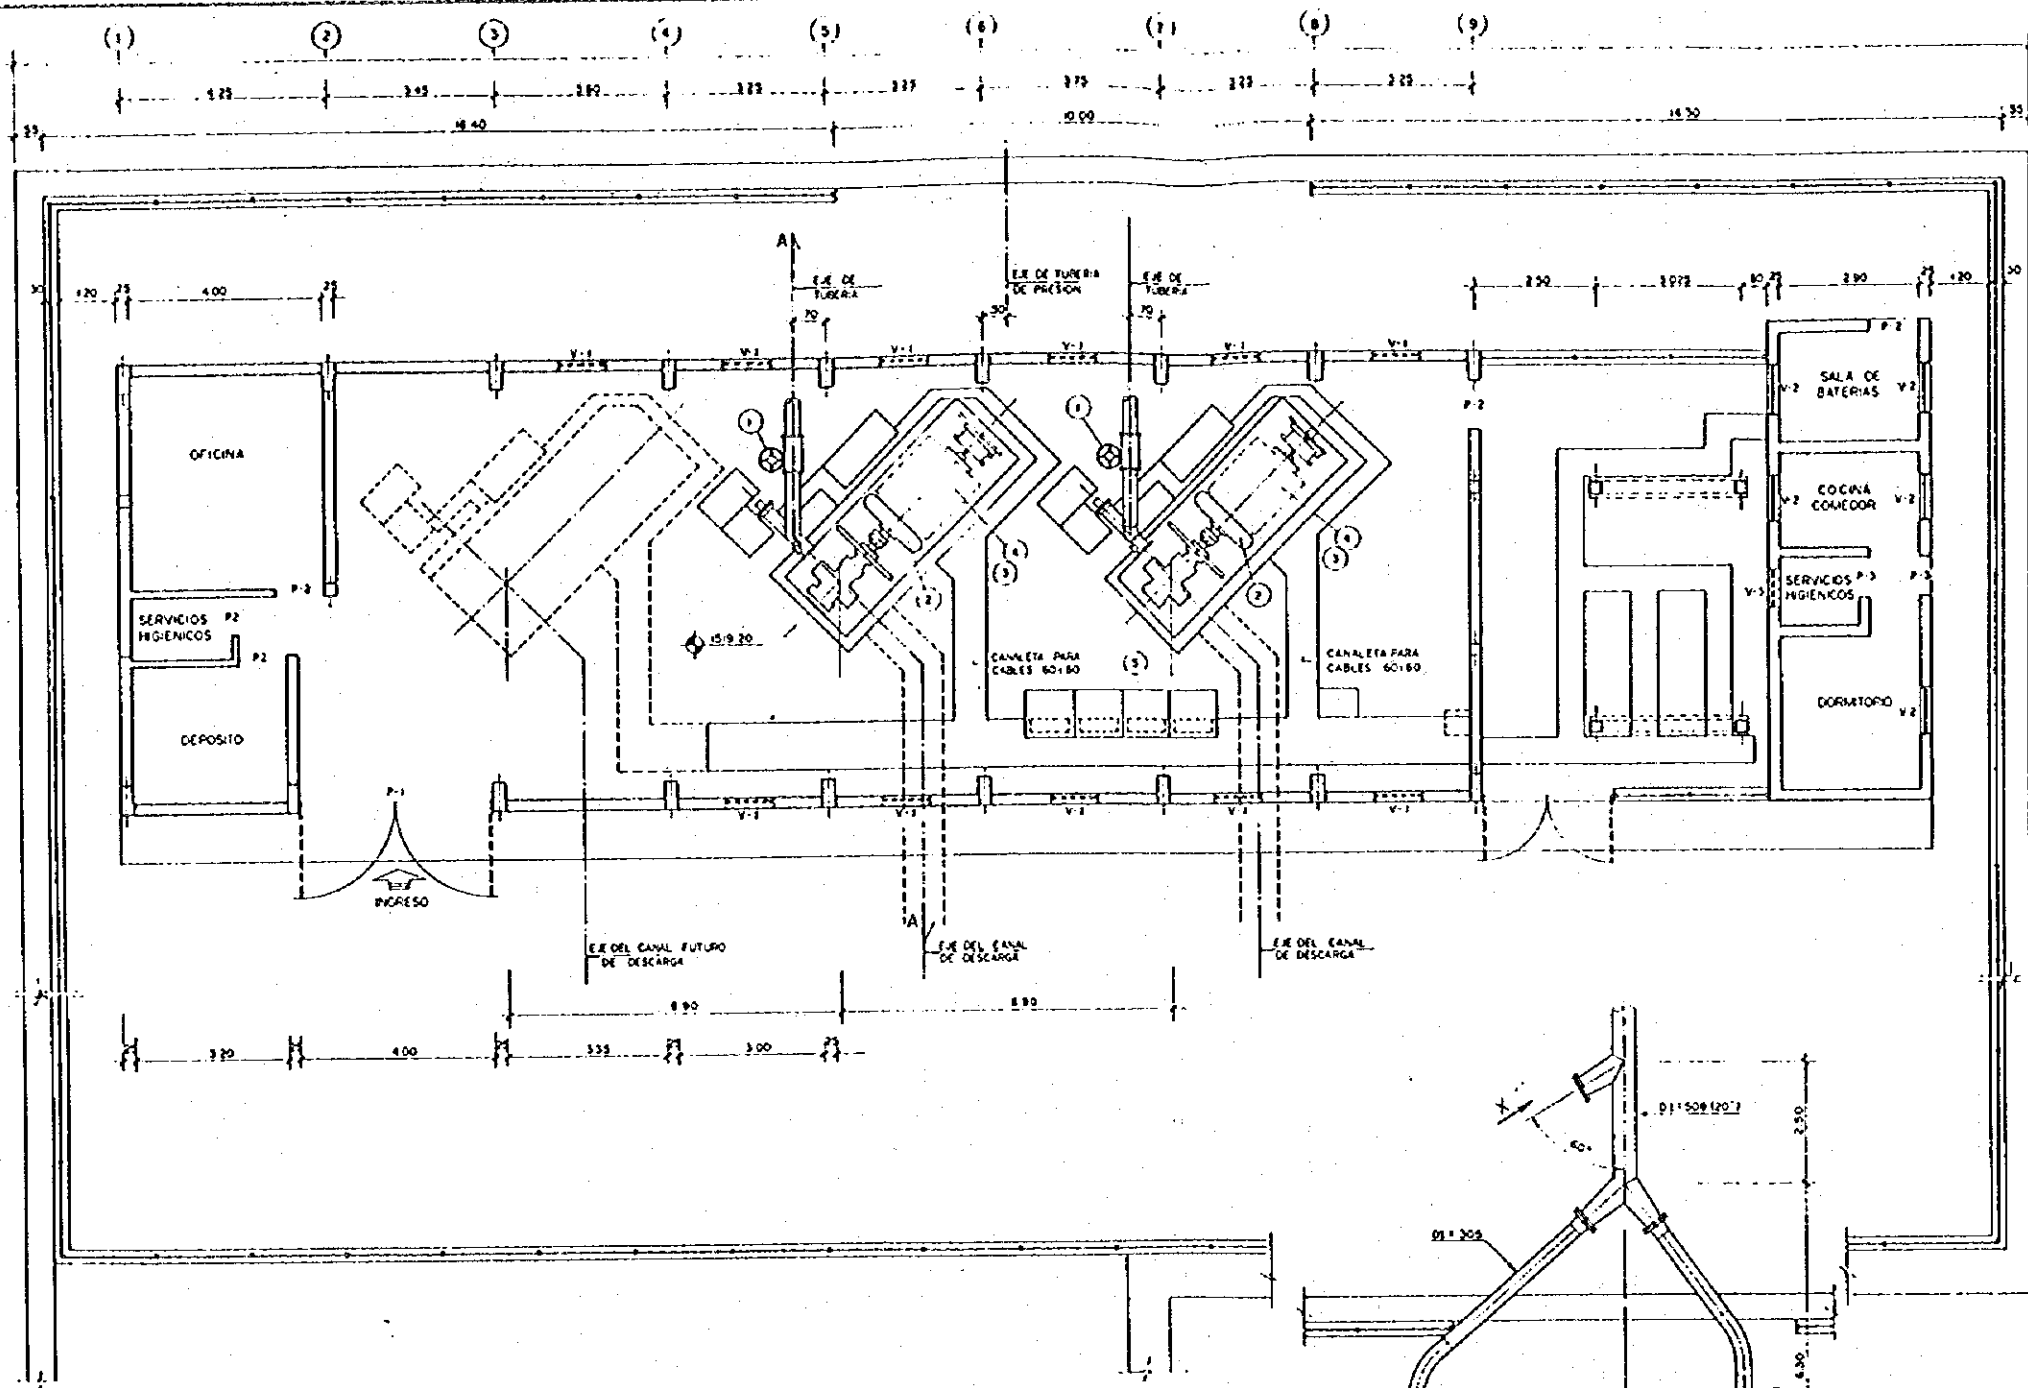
Tubería Forzada - Planta y Perfil (2/2)
